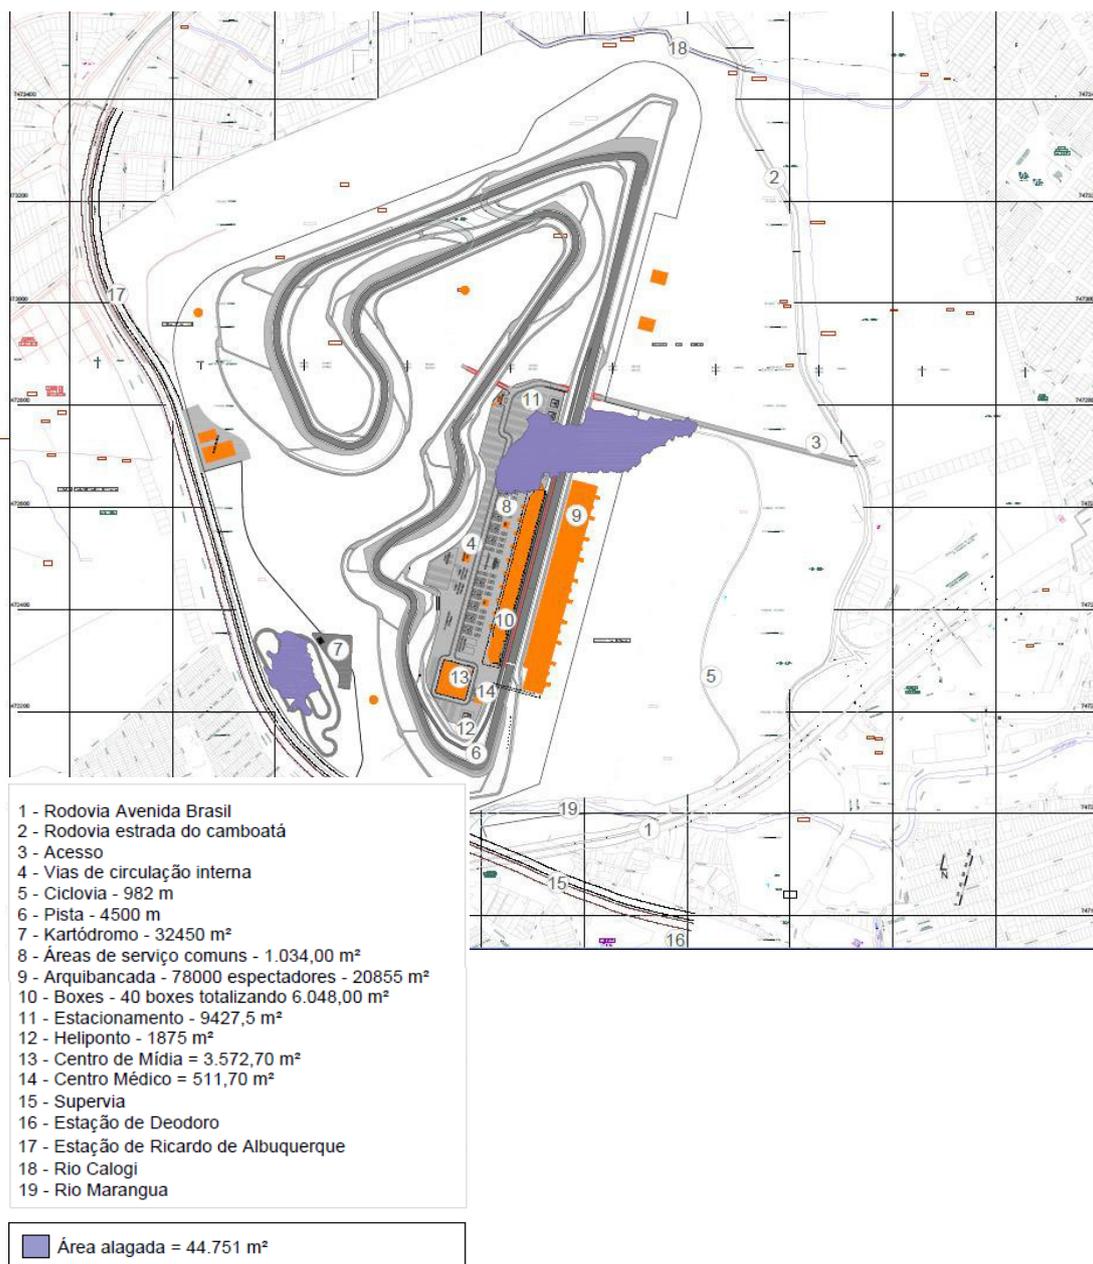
Planta de Implantação do empreendimento apresentado no EIA.
